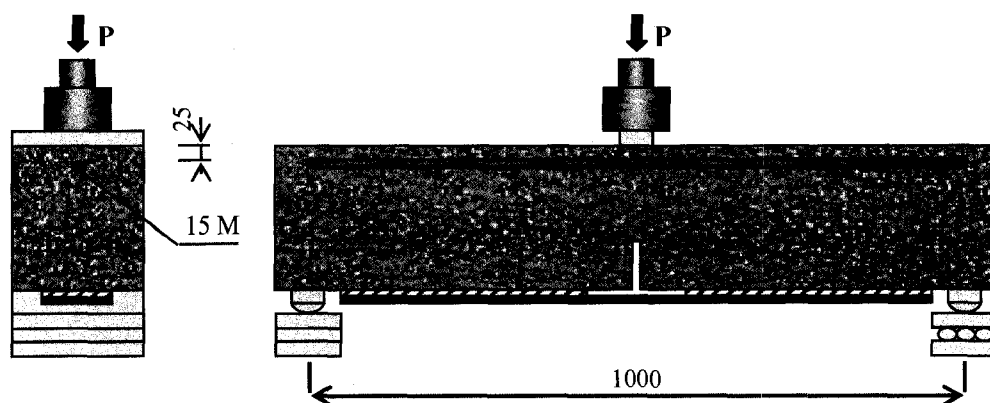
Poutrelles du Groupe A : sans renforcement en cisaillement
